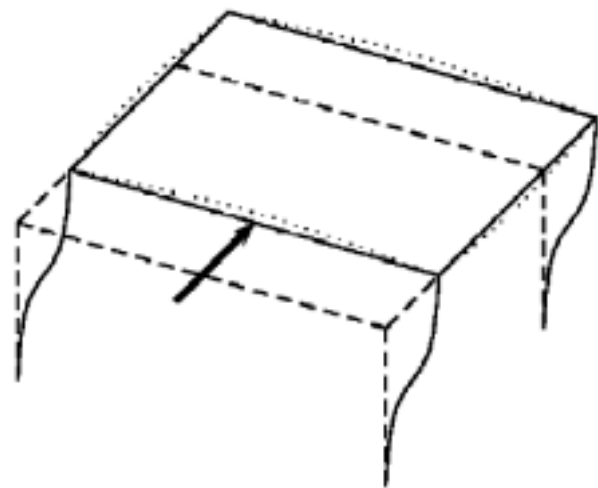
Diagramas flexible (...) y rígido (—) en su plano.
